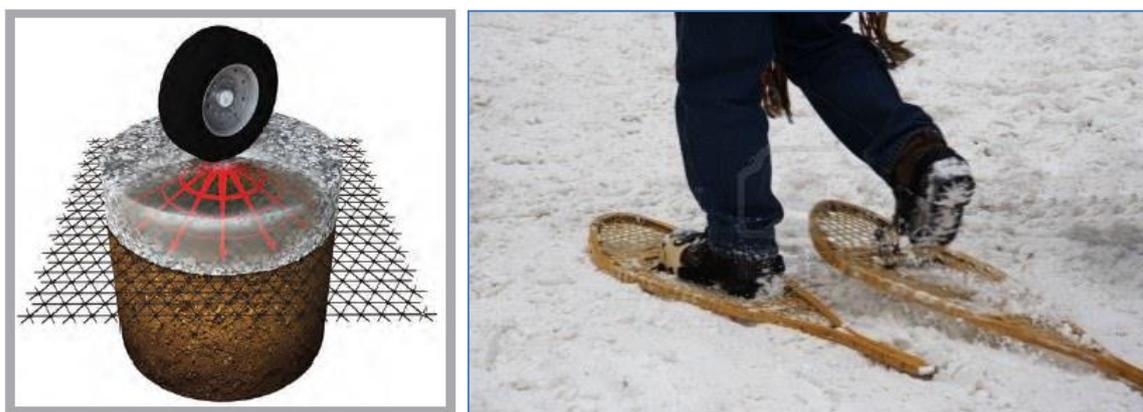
Distribución de cargas similar a un zapato de nieve.(Fuente: Use of Geogrids in Pavement Construction. USACOE ETL 1110-1-189)
